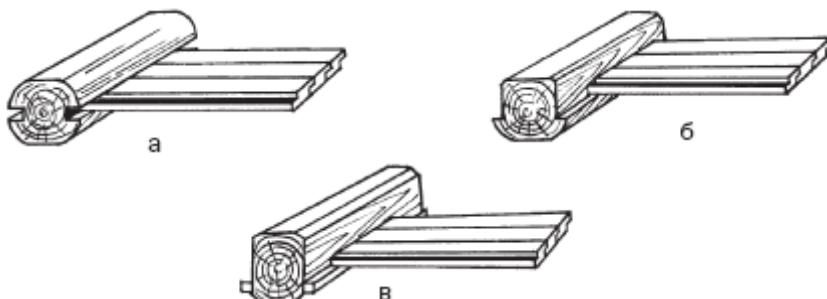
Устройство черного пола: а – балка со шпунтами; б – балка с черепом; в – балка с черепными брусками
